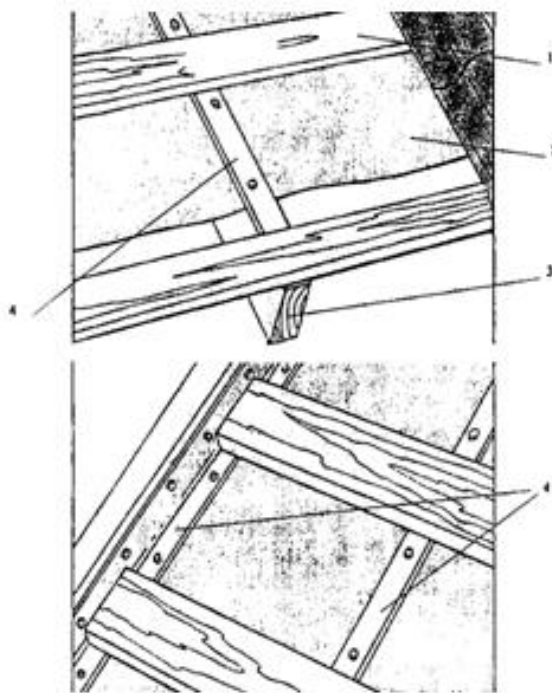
Укладка гидроизоляционной прокладки на стропила:
